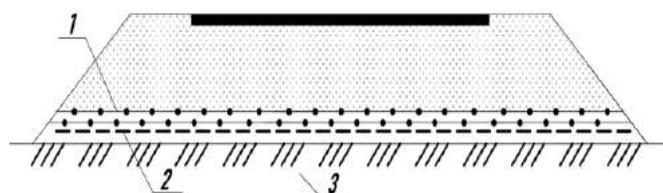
Многослойное армирование: 1-армирующие слои; 2-разделительный слой (нетканый материал), уложен прямо на основание; 3- грунт с низкой несущей способностью.
